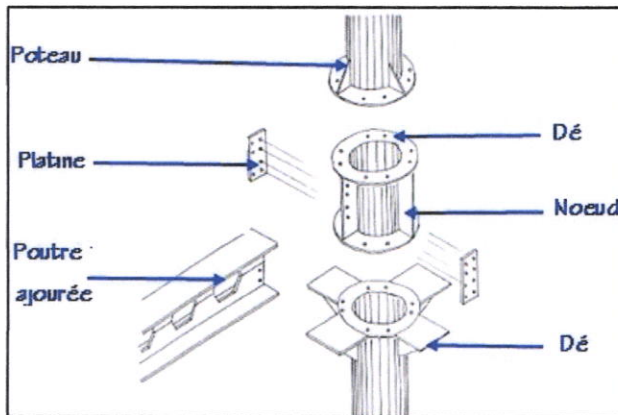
jonction poteau-poteau ; source : auteurs 2018.
